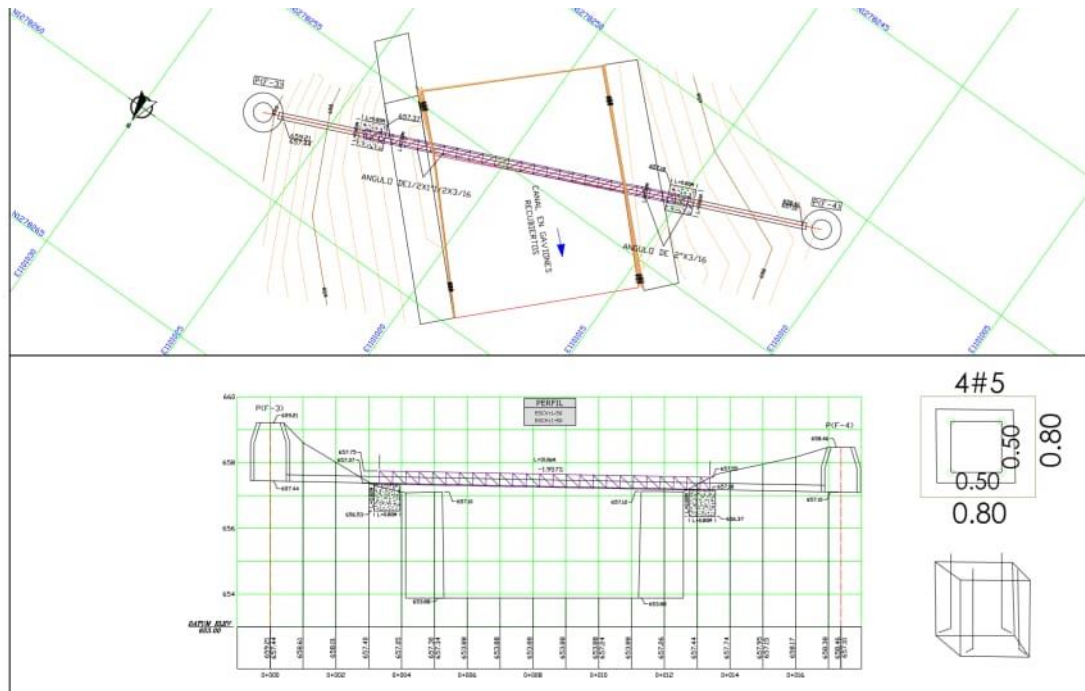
Esquema de diseño de paso elevado revisado por topógrafo e ingeniero residente de obra.
